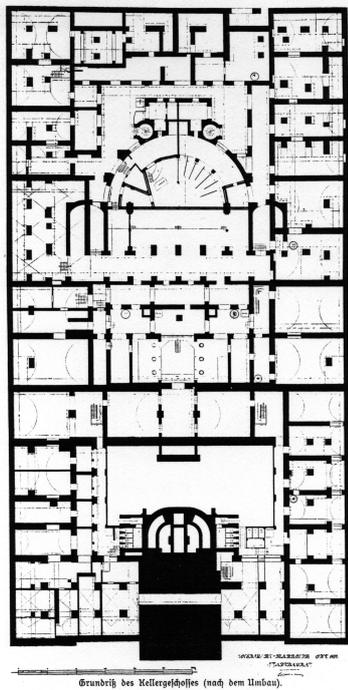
Grundriß des Kellergeschoßes nach dem Umbau
